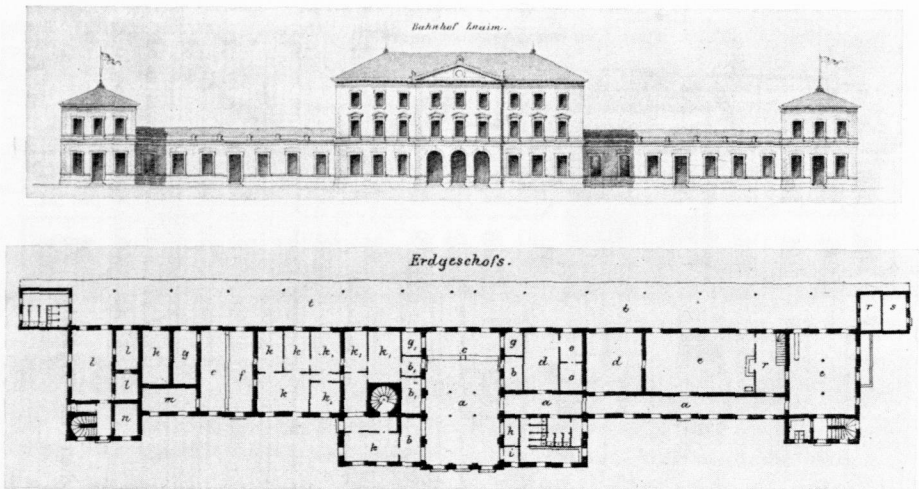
Der Bahnhof Znaim der Österreichischen Nord-Westbahn, Fassade und Grundriß des Erdgeschosses, um 1870
